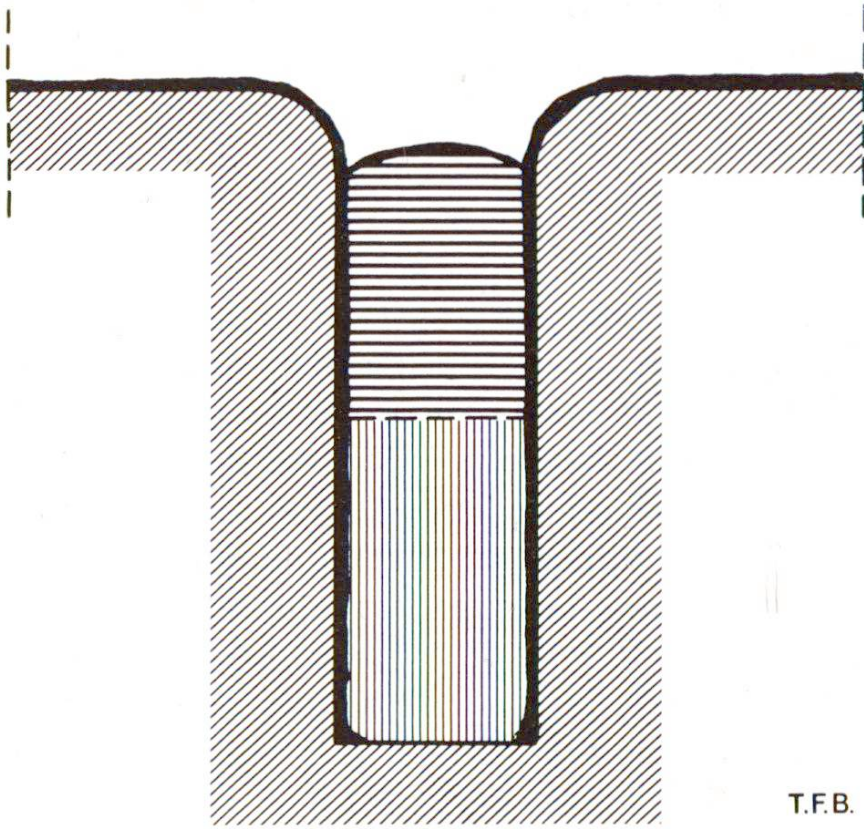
Joint avec corps de joint et masse de scellement. Les arêtes sont arrondies et les parois bien planes. L'enduit de protection est appliqué également sur les parois, jusqu'au fond du joint.
